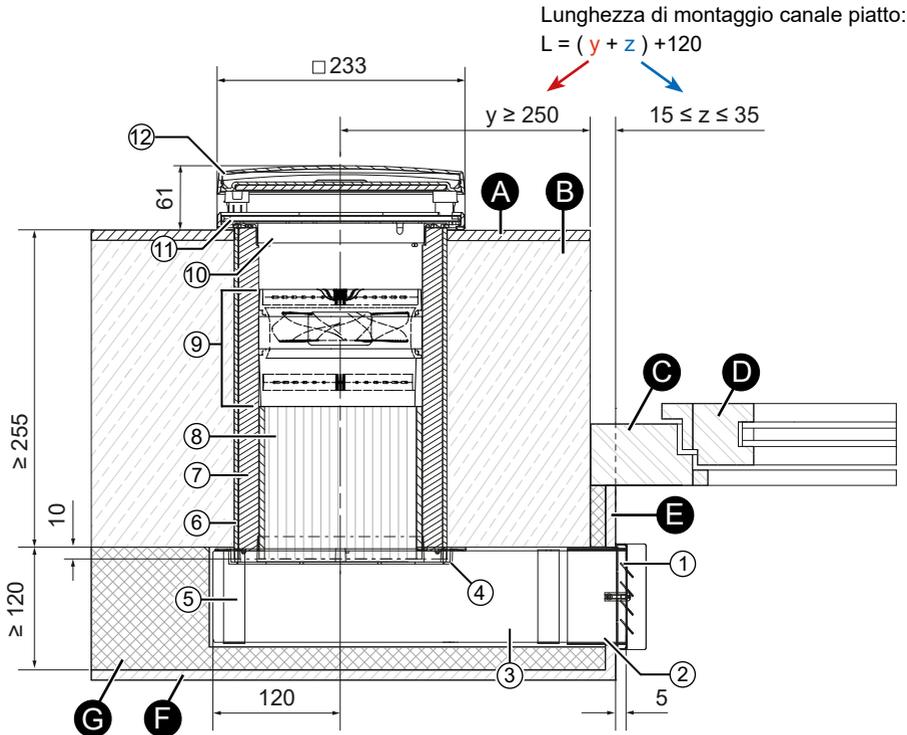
disegno in sezione del dispositivo iV14-Zero Corner (vista dall'alto)
